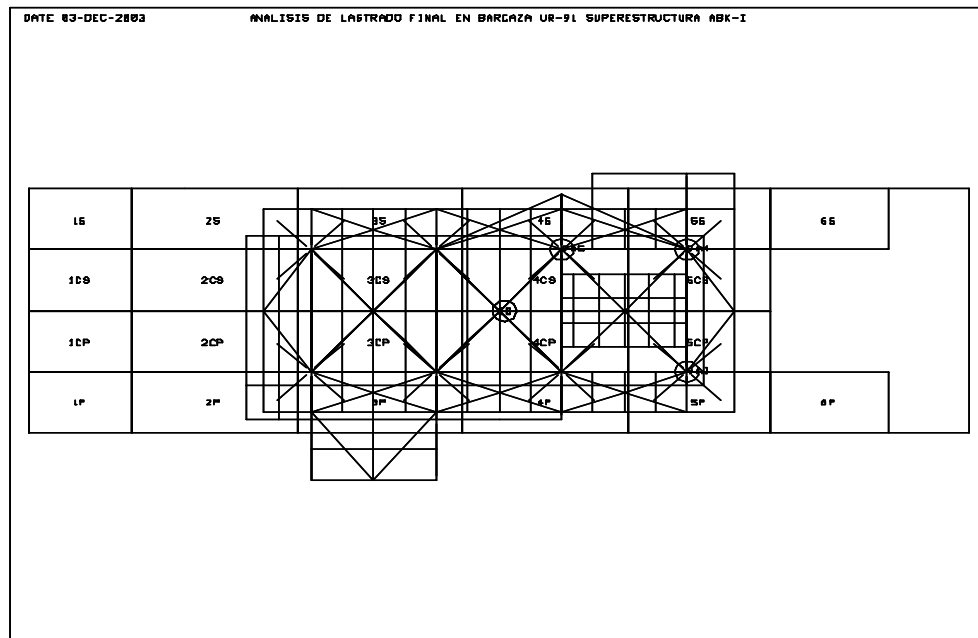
VISTA EN PLANTA DEL SISTEMA BARCAZA-SUPERESTRUCTURA
